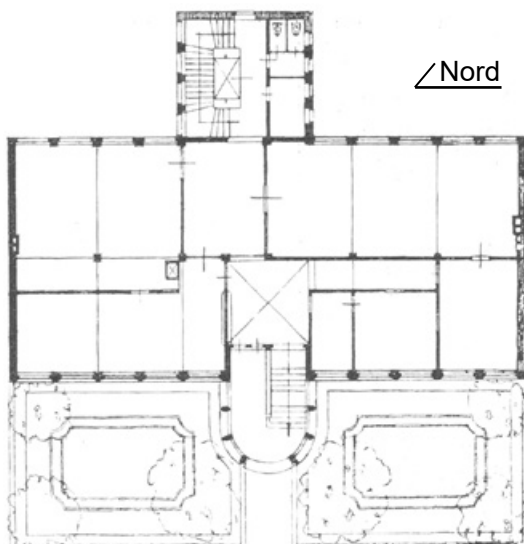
Grundriss (SBZ 1913, S. 256).
